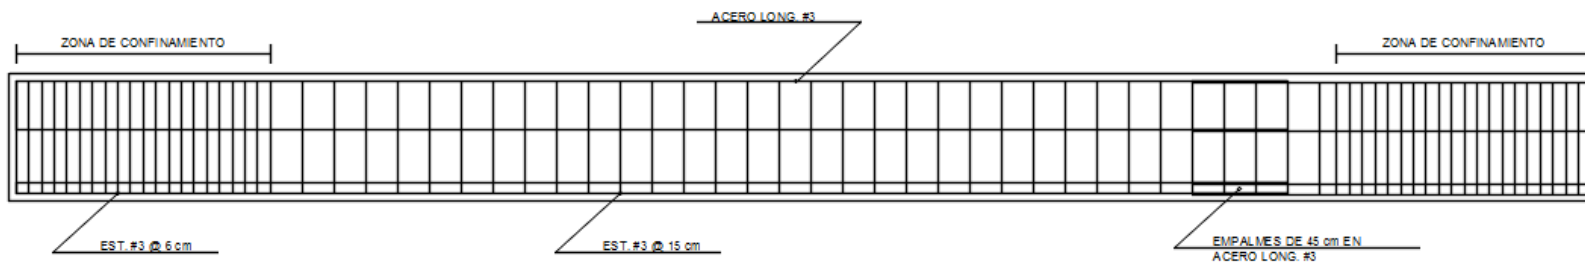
Plano de taller para viga V - 1, sección longitudinal
